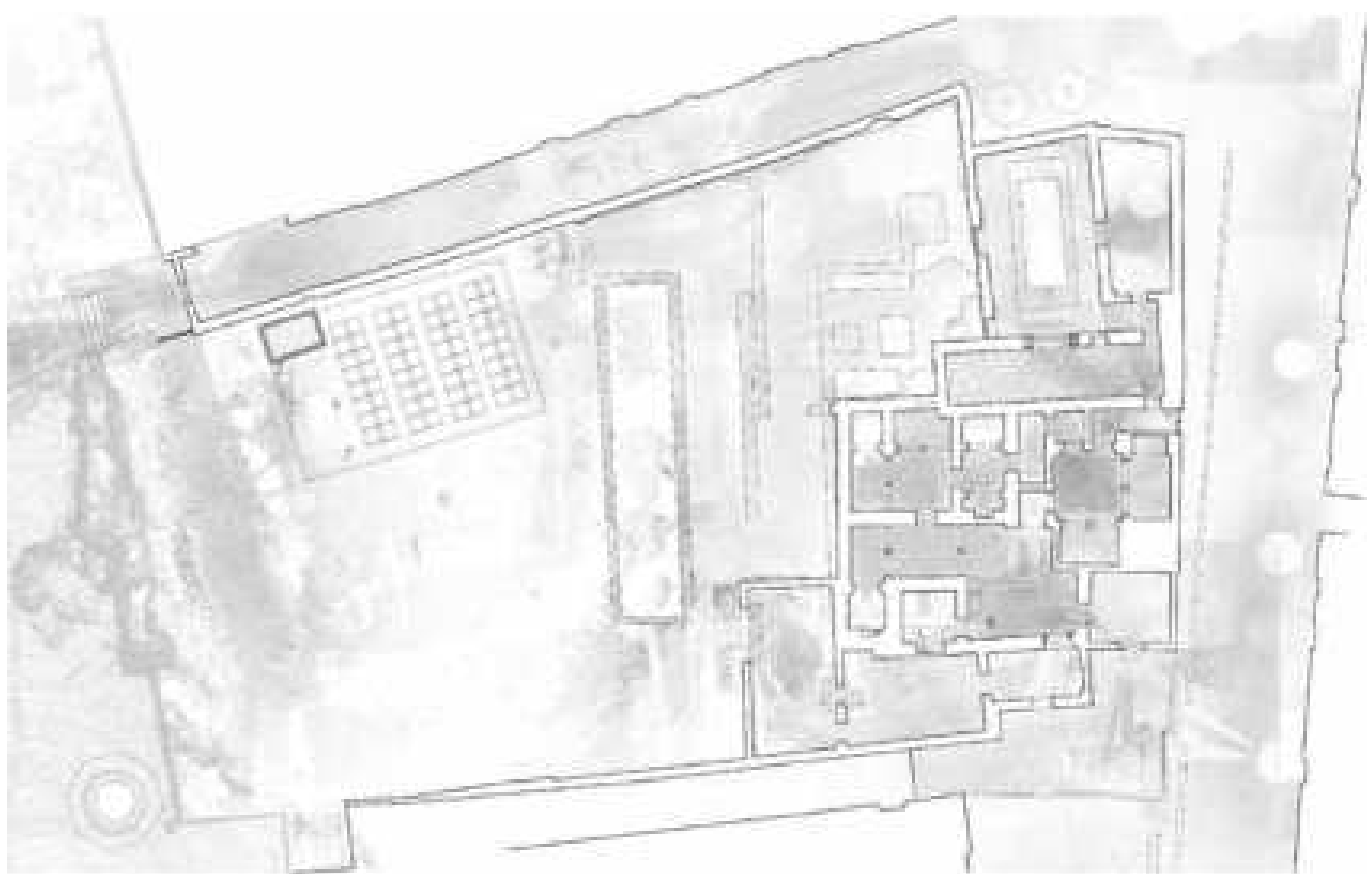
Planimetria livello 0 (piano di taglio +1.50m).
